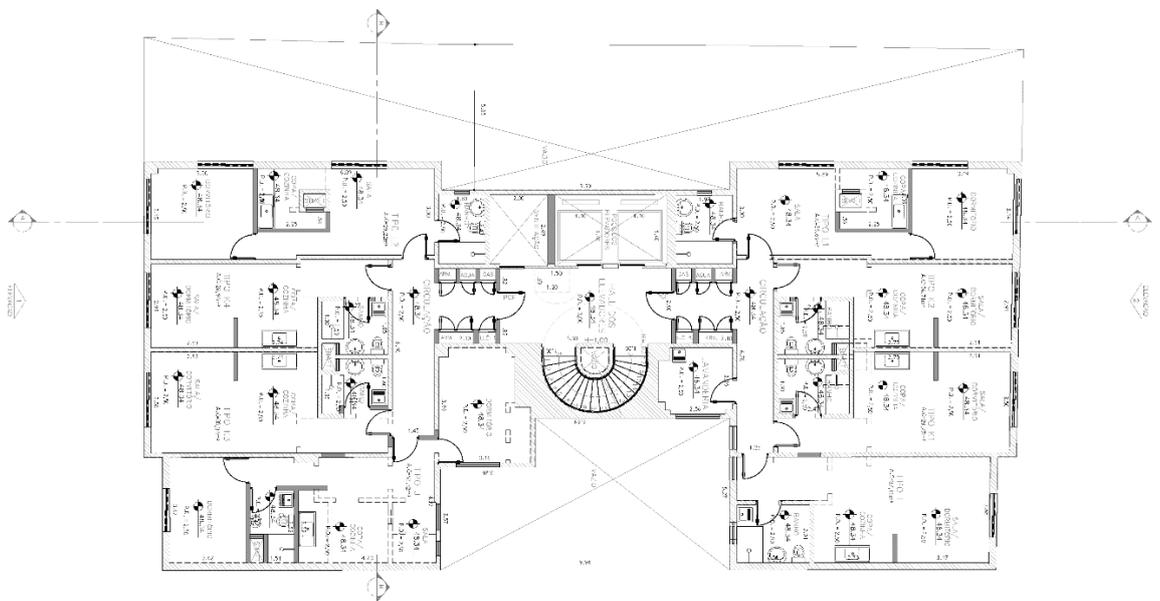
Planta tipo, projeto COHAB. Fonte: COHAB
